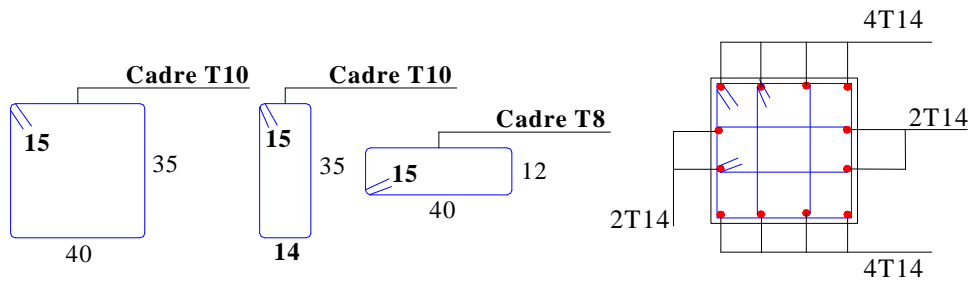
Schéma de ferrailage des poteaux étage 07 et 08
